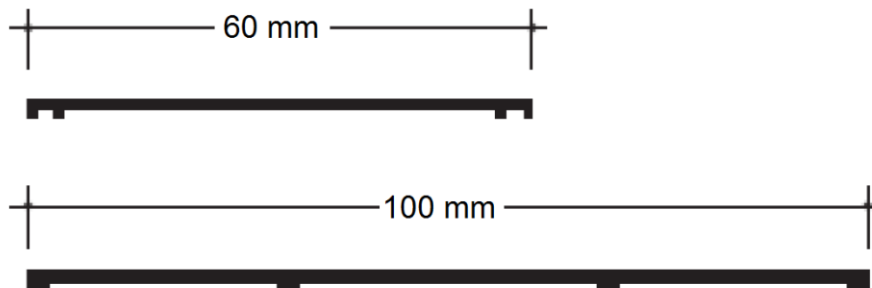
Exemple de bande PVC ou EPDM sur chevrons pour bande de protection
